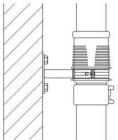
Collier point fixe isolé contre le bruit sur le manchon long Geberit Silent-db20
